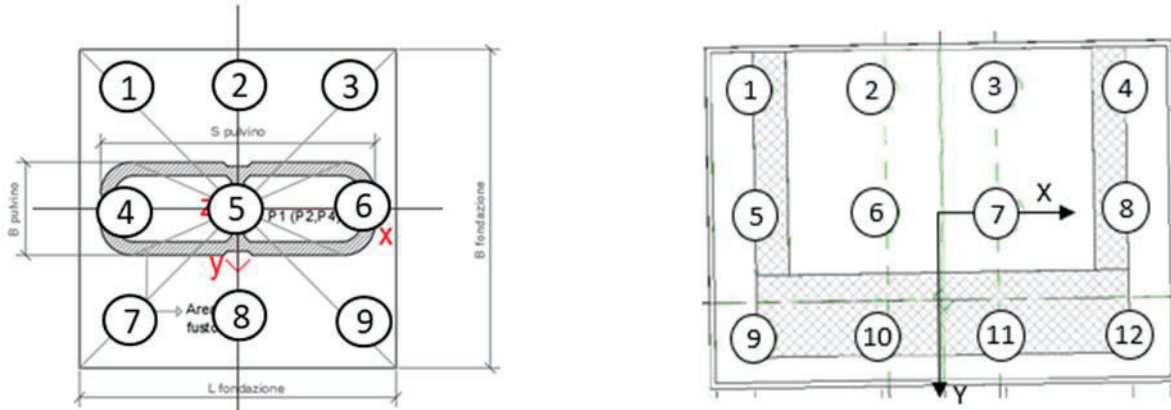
Sistema di riferimento per le fondazioni delle pile e delle spalle con indicazione della numerazione dei pali.
